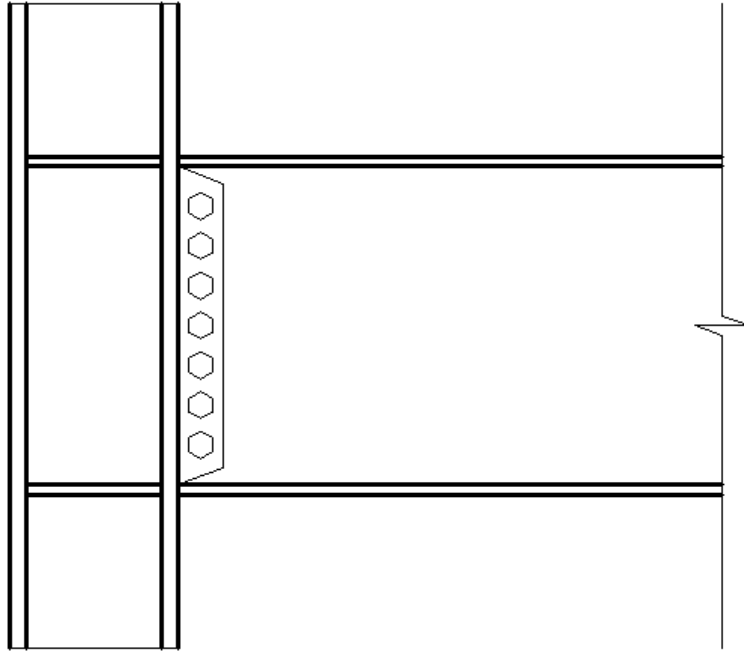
Corte para detalle de la conexión soldada, atornillada no reforzada.
